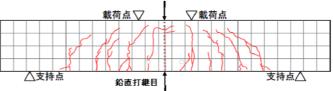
打継面の目粗し試験体のひび割れ状況
